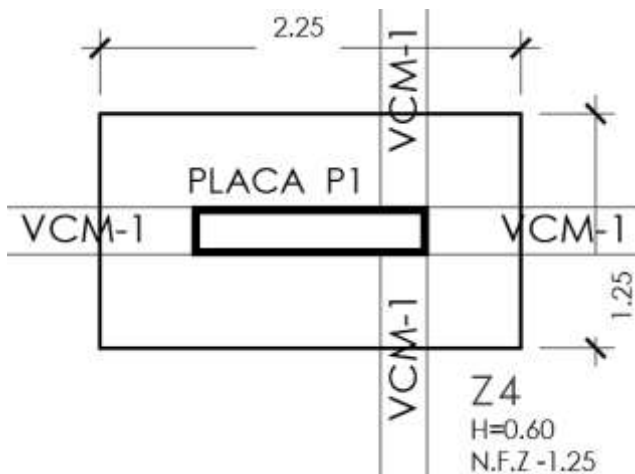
Propuesta de Concreto Armado, zapata Z4 a diseñar
